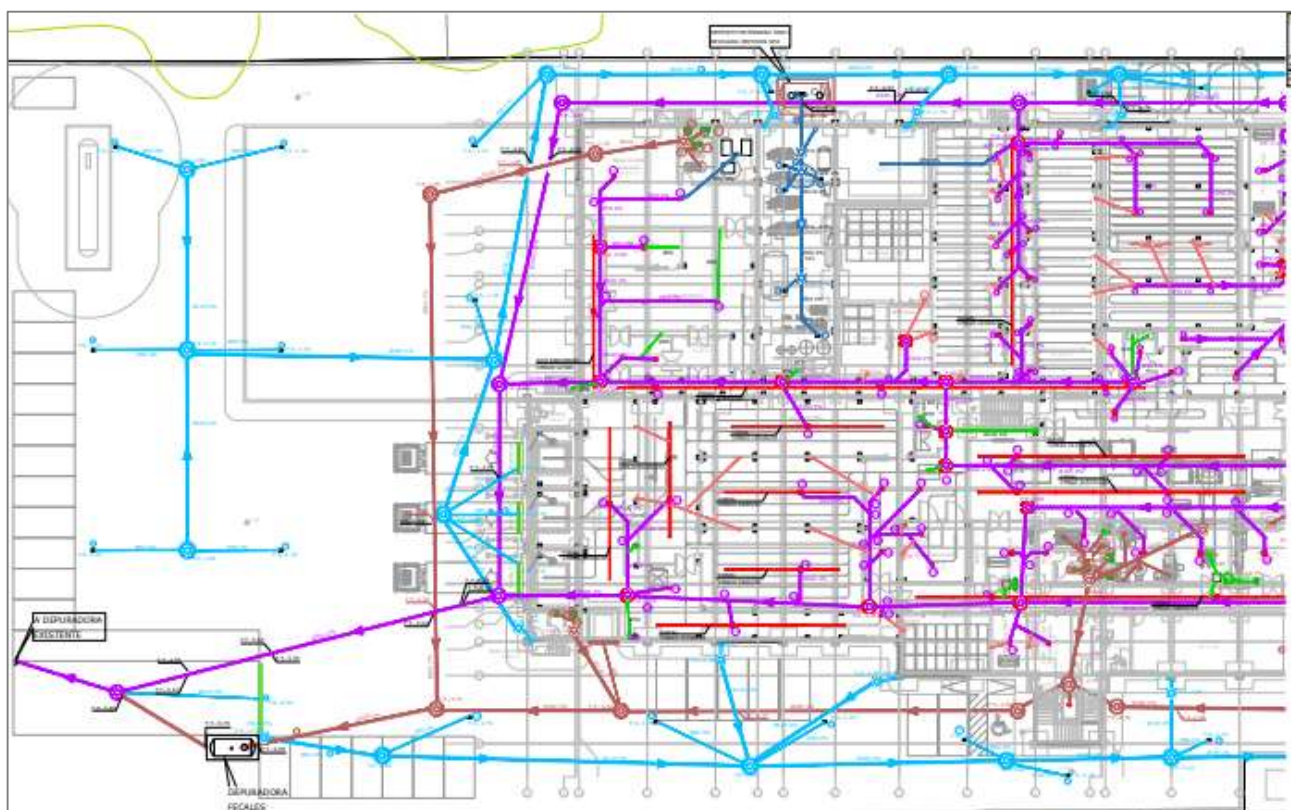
Planta general de la red de pluviales. Fuente: Proyecto Definitivo de Ejecución
